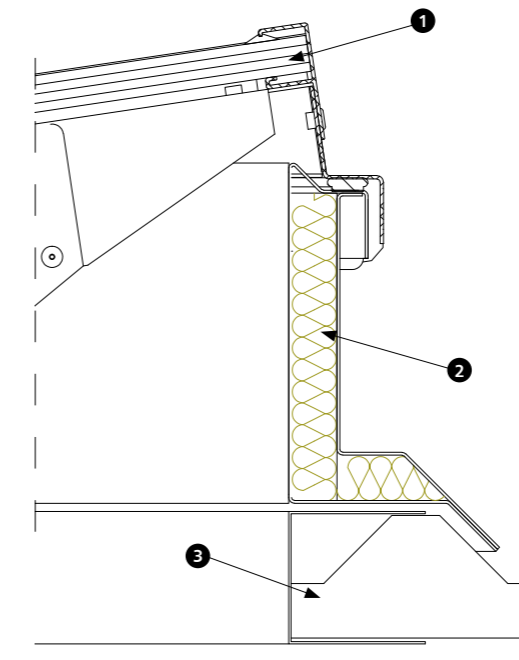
Montage des Lamellenlüfters auf Flachdachsystem mit Stahltrapezprofil
